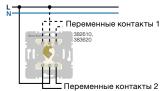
Выключатель/переключатель 1- и 2-полюсный для профильных полуцилиндров [№ для заказа 3826 10, 3836 20]
